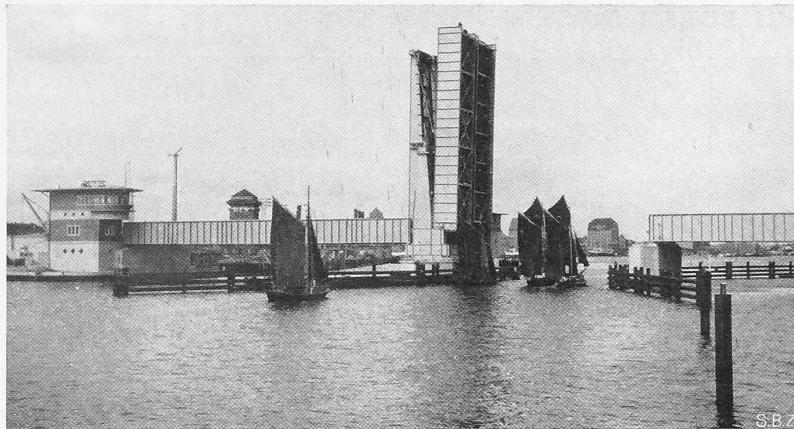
Eisenbahn- und Strassen-Klapptbrücke des Rügendamms, Stützweite 29 m.
